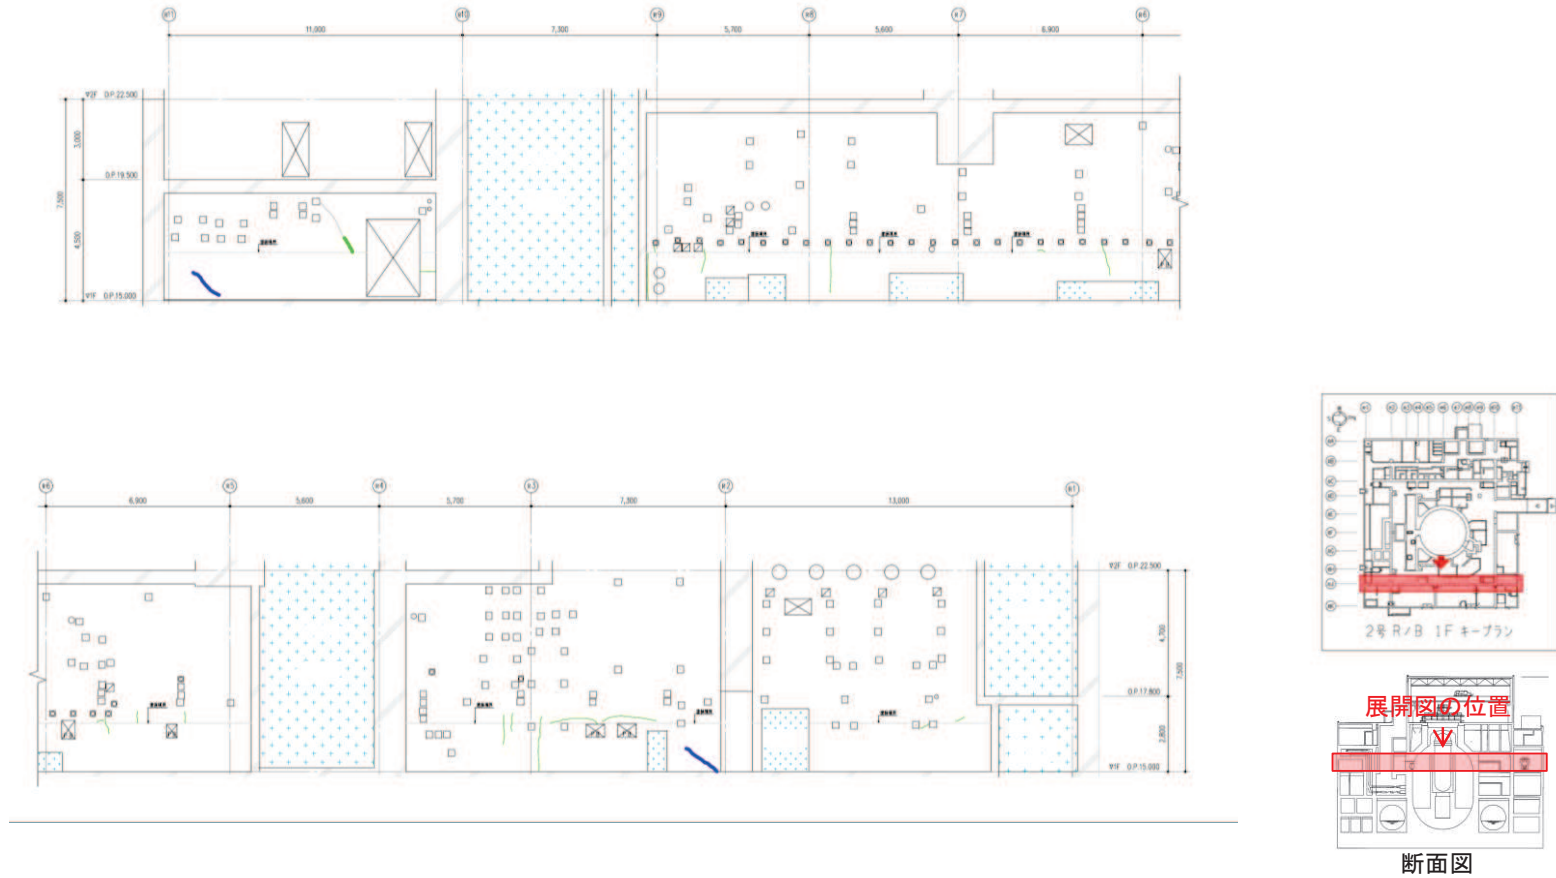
(1) 原子炉建屋のひび割れ分布 (耐震壁 地上1階 RC 通り)
